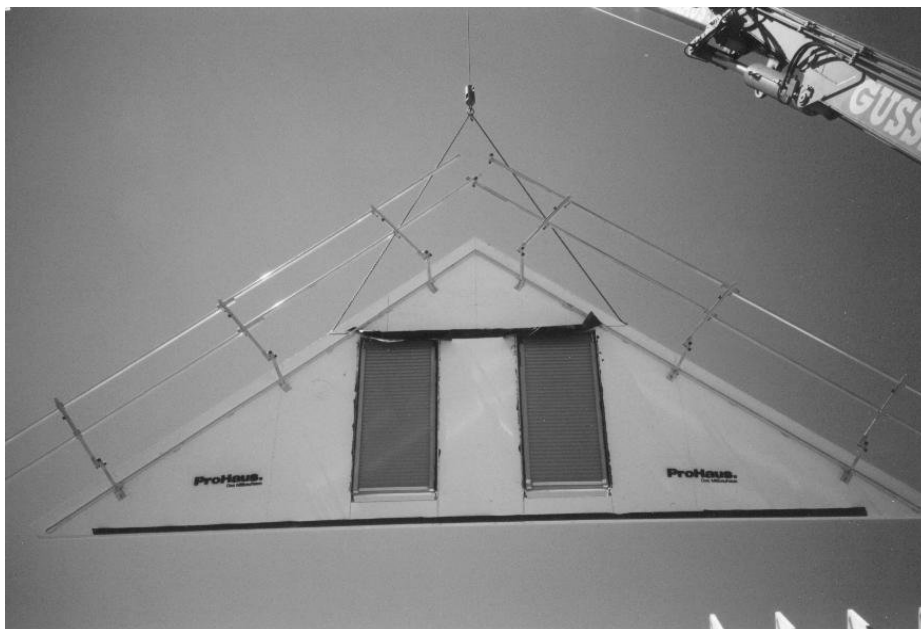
Dachelement mit bereits vormontiertem Seitenschutz
